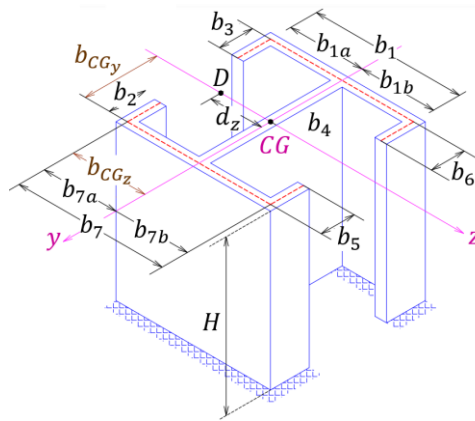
Pilar de madeira em paredes finas duplamente simétrica com a geometria do núcleo duplo T
